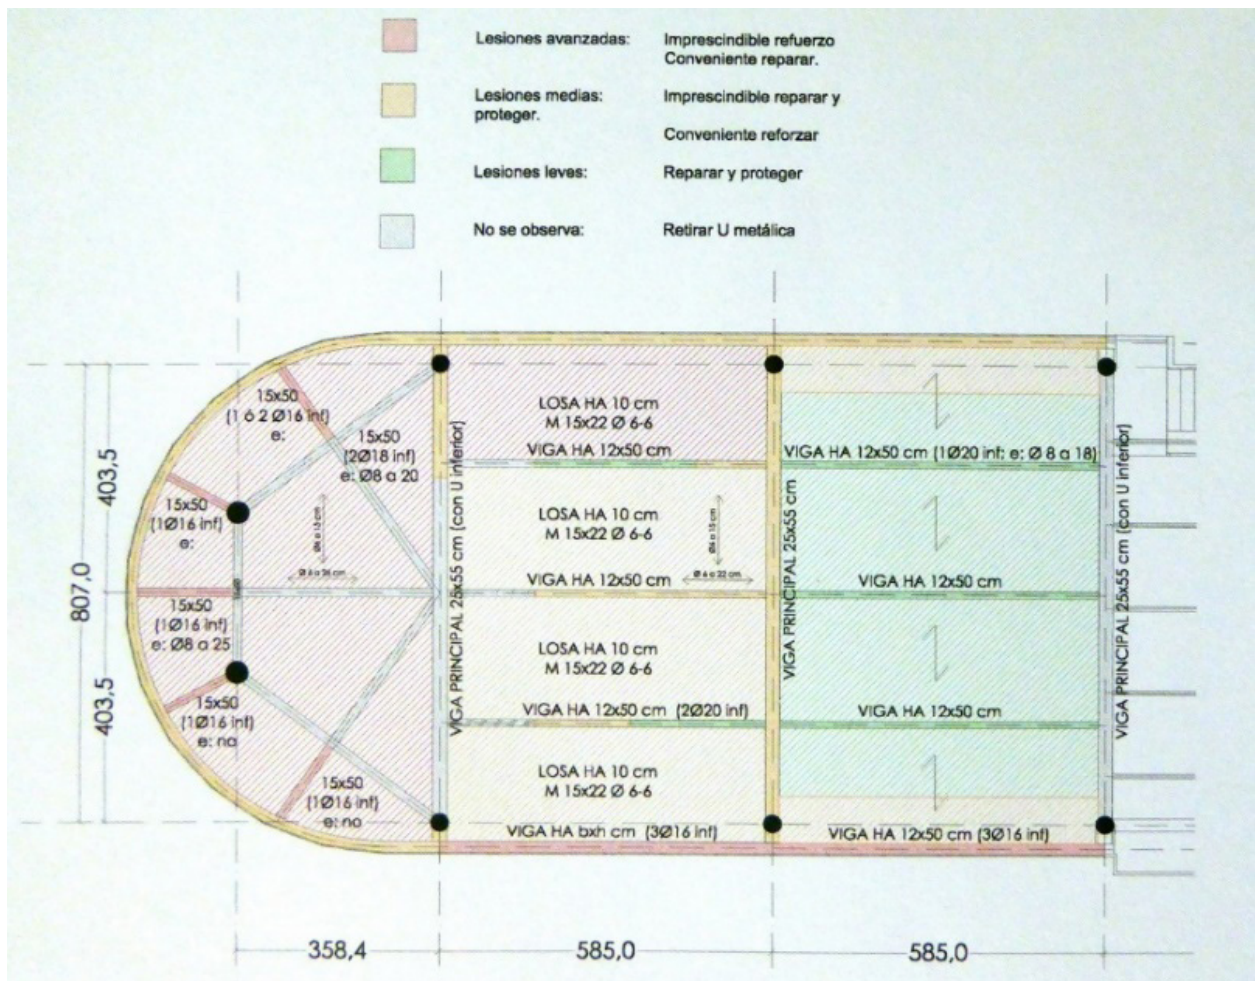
Plano de lesiones y estado de estructura de cubierta de la segunda planta del Real Club Náutico de San Sebastián. 2013. Beatriz Gil Rodríguez
